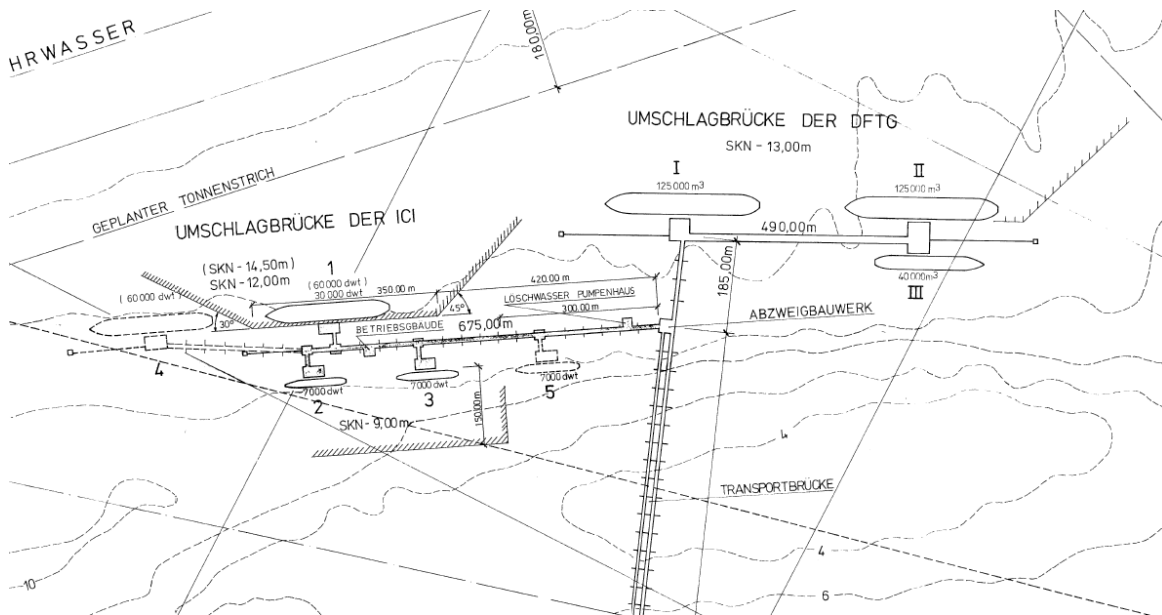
Planausschnitt Planunterlage zum Planfeststellungsbeschluss vom 29.03.1979
